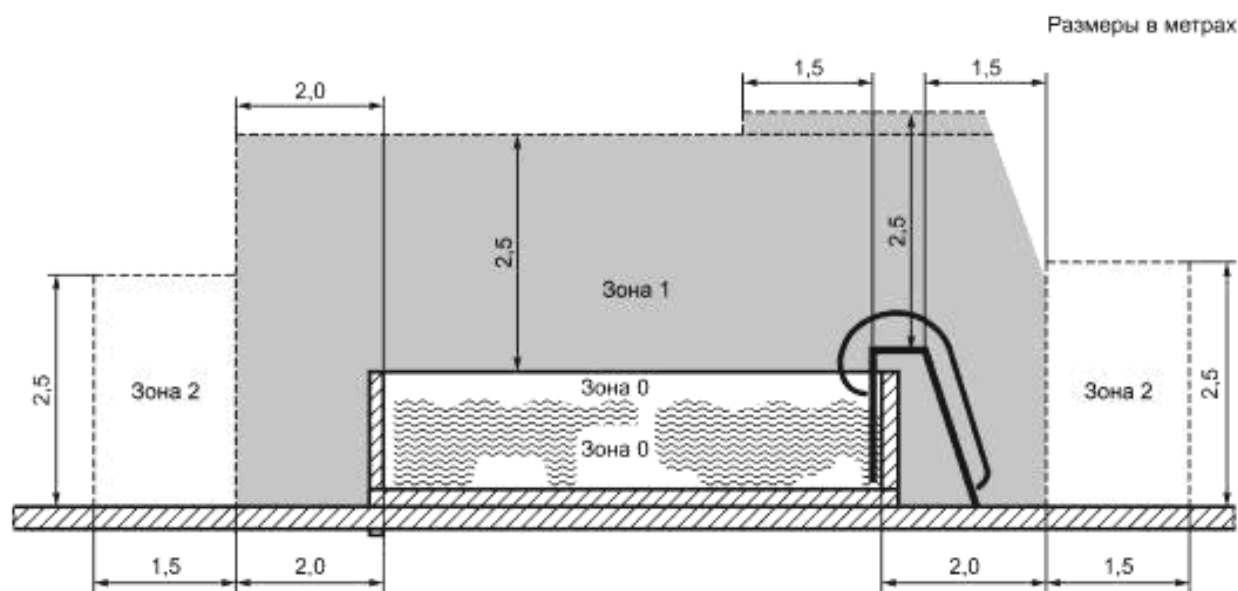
Размеры зон для плавательных бассейнов и лягушатников (вид сбоку)
